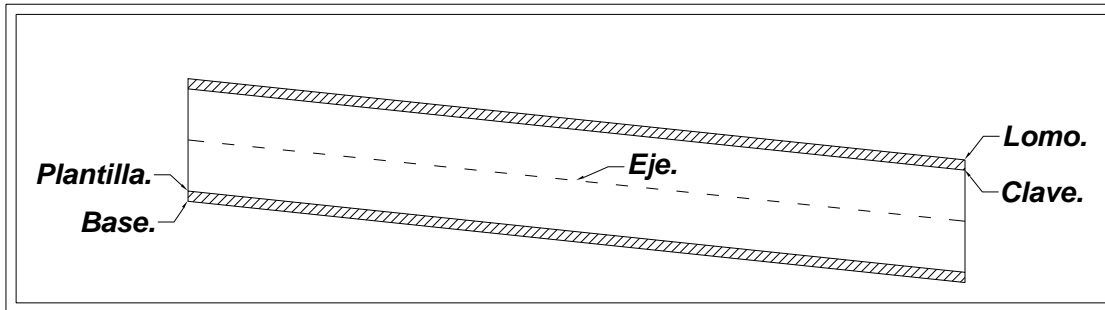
Corte Transversal – longitudinal de una conducción.
